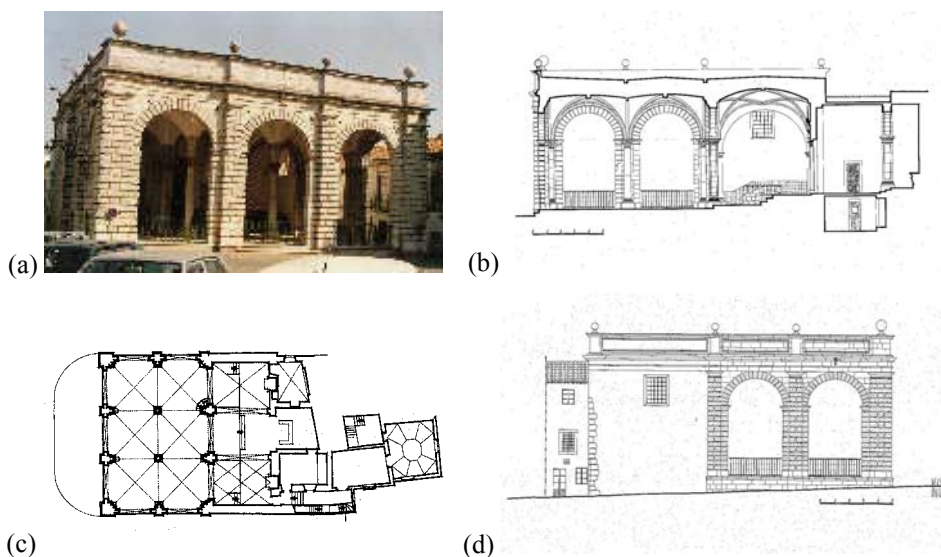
Peças desenhadas [DGEMN]: (a) fotografia da fachada; (b) planta; (c) corte longitudinal; (d) alçado lateral.
